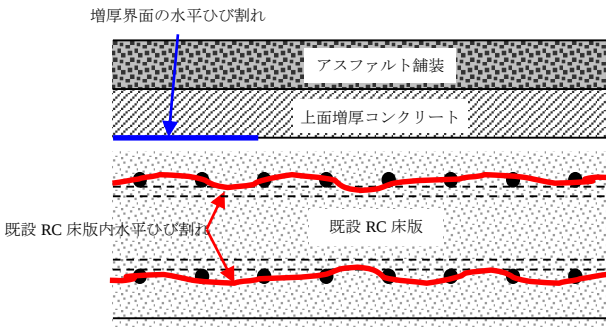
RC 床版内の水平ひび割れ¹⁾
